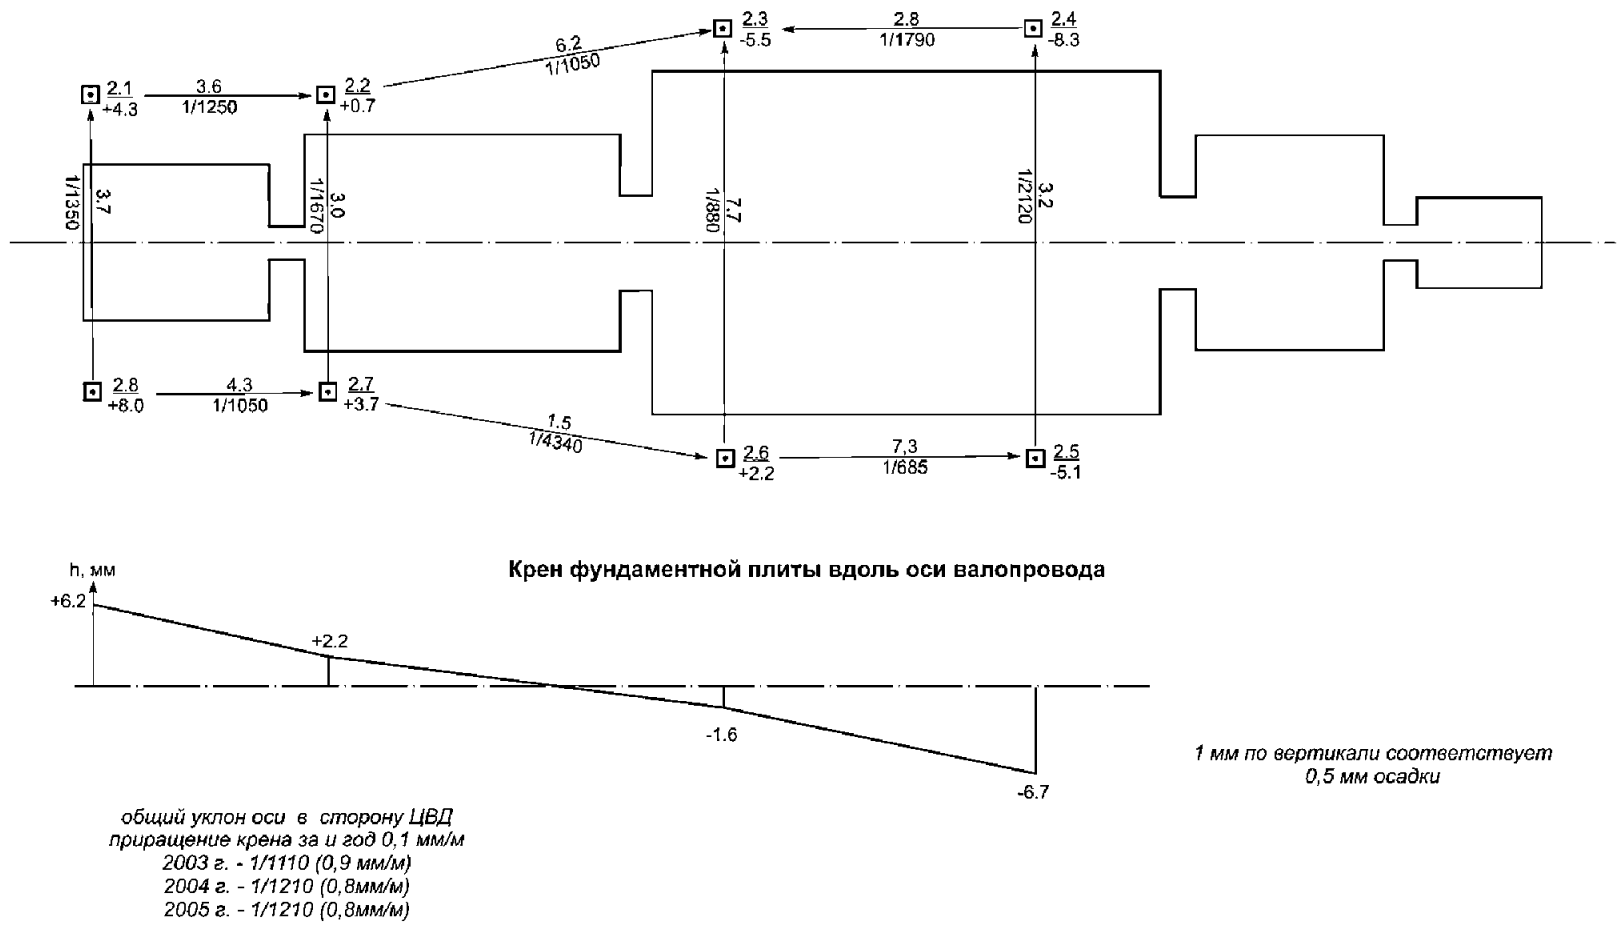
Схема продольных и поперечных кренов верхней фундаментной плиты турбоагрегата
